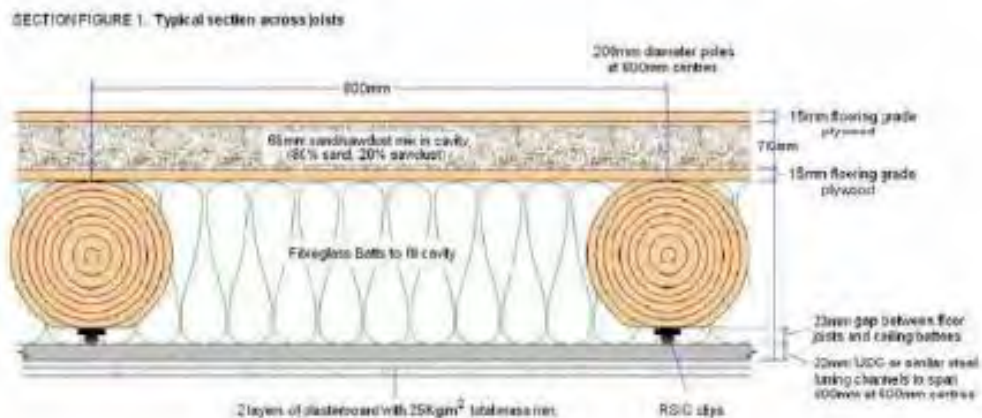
Immagine tratta da "Integrating cross-laminated timber panels to construct buildings to twenty levels" John Chapman.
